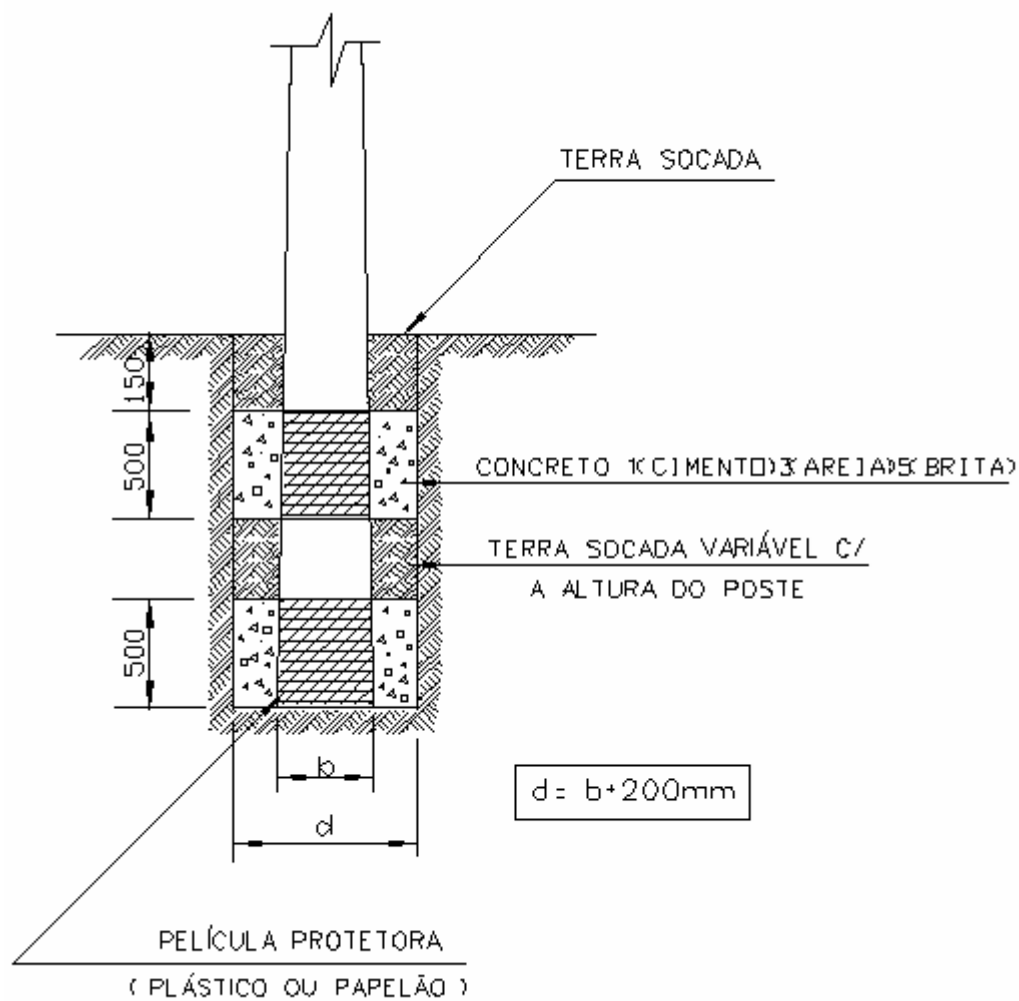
ENGASTAMENTO COM CONCRETAGEM DE CAVA
